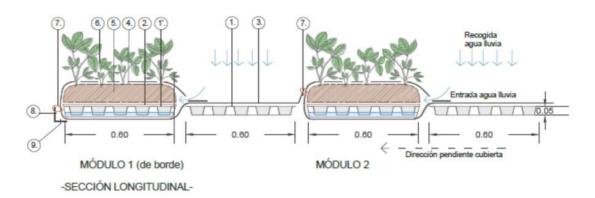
Detalle constructivo mBiGTray. Fuente: Proyecto básico y de ejecución Colegio EB1 – Horta das Figueiras
